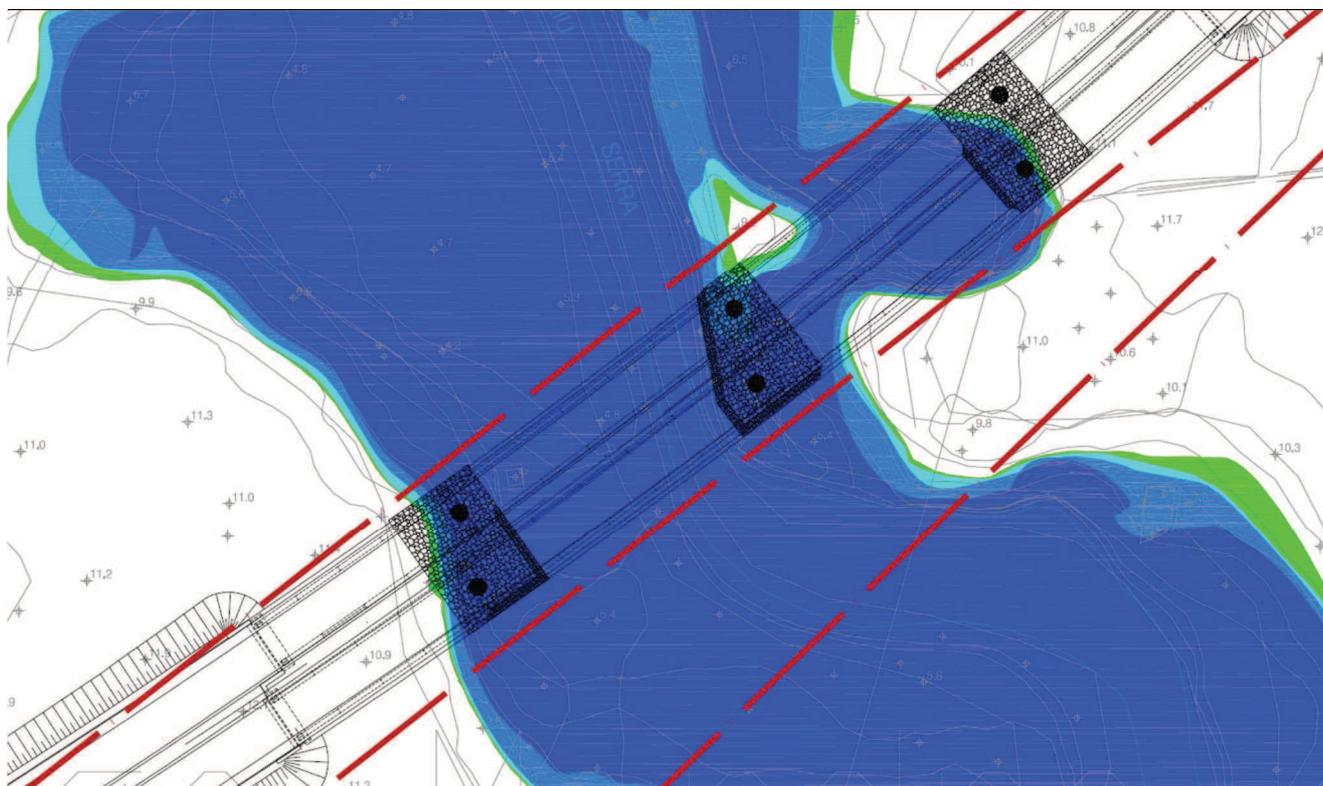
Viadotto Serra. Planimetria delle aree di esondazione Post-operam
